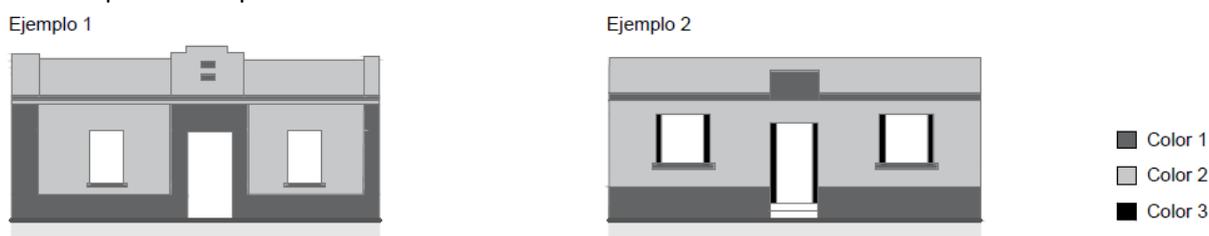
Ejemplo de pintura de fachada para construcciones de la población San José.
